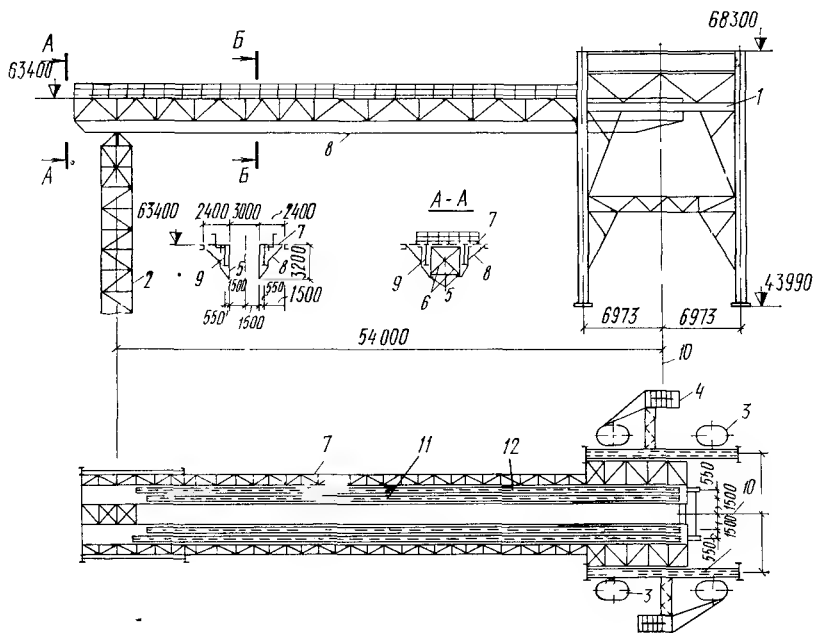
Удлиненная монтажная балка, опирающаяся на гибкую опору
